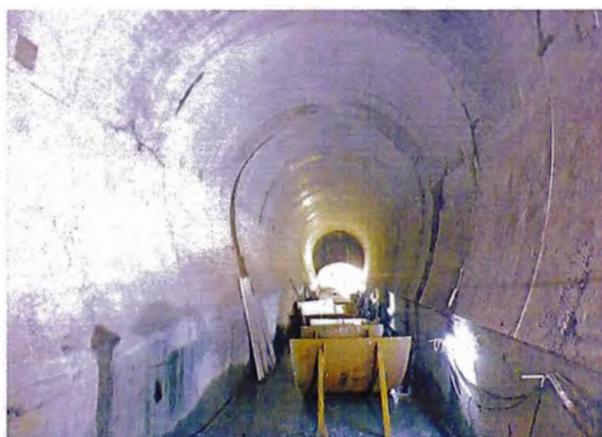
Túnel de Conducción- Zona de Intersección con Cámara Carga
